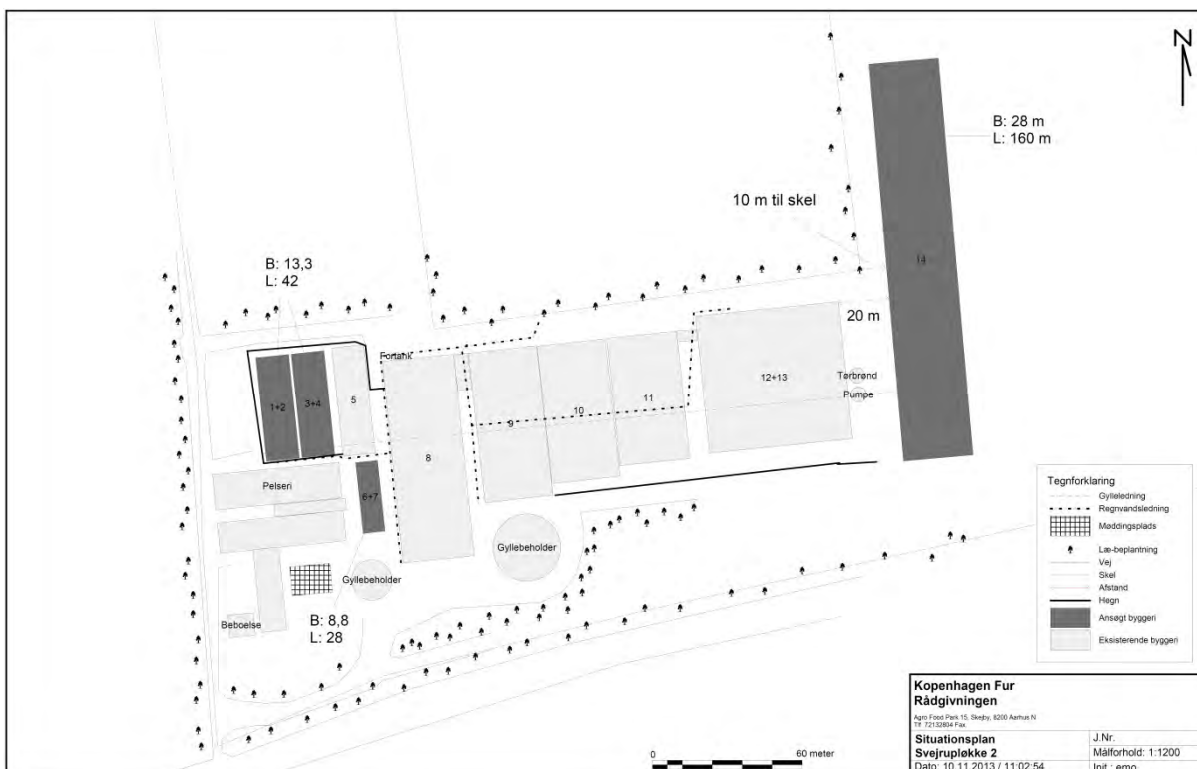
Oversigtskort, som viser placering af eksisterende- og nye minkhaller, gyllebeholdere, mv.
